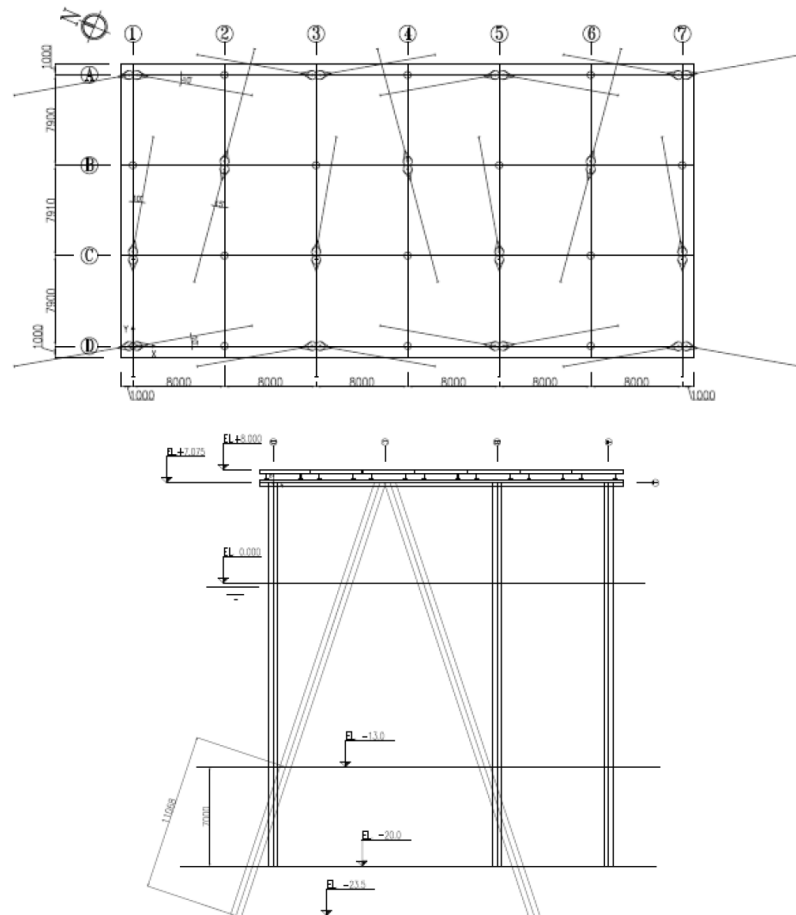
Esquema de planta y perfil tipo del cabezo (Planos de Construcción, Calbuco Ingenieros).
